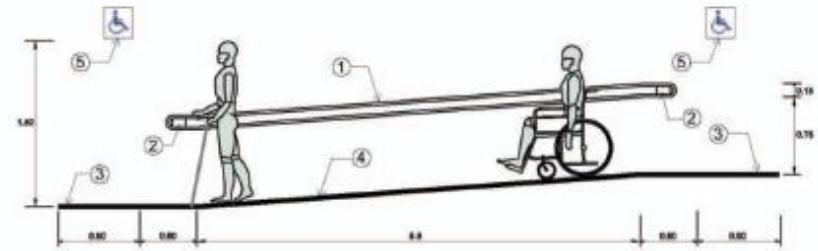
Detalle de rampas. Planta y Alzado. Fuente: INIFED
